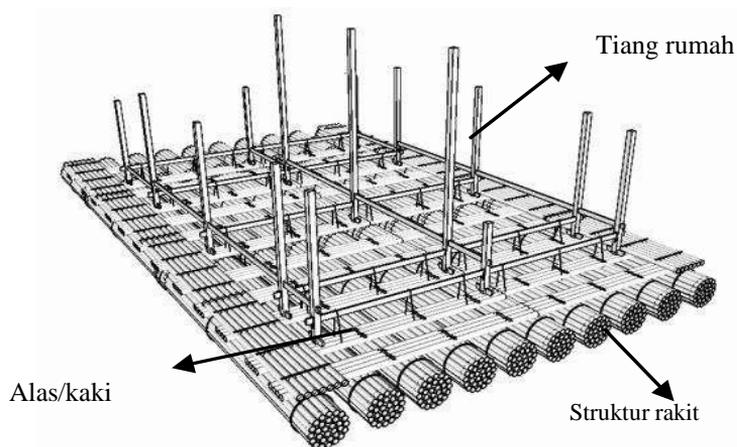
Detail Struktur Tiang Bawah dengan Alas Kaki Tipe Aladin
